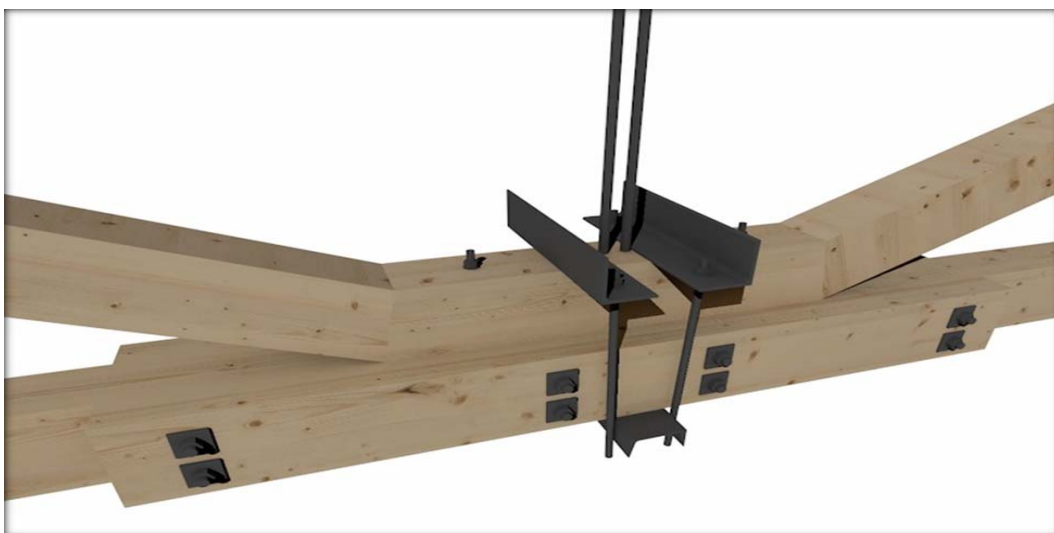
Информационная модель среднего узла нижнего пояса фермы
